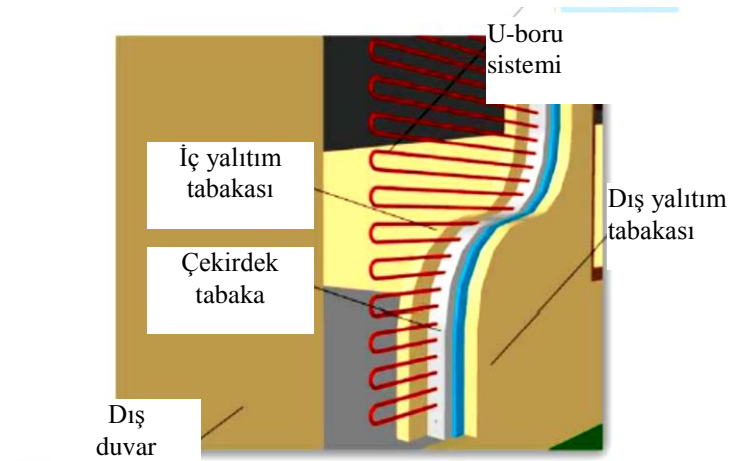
Temel beton yapısına boruların yerleşimi [30]
